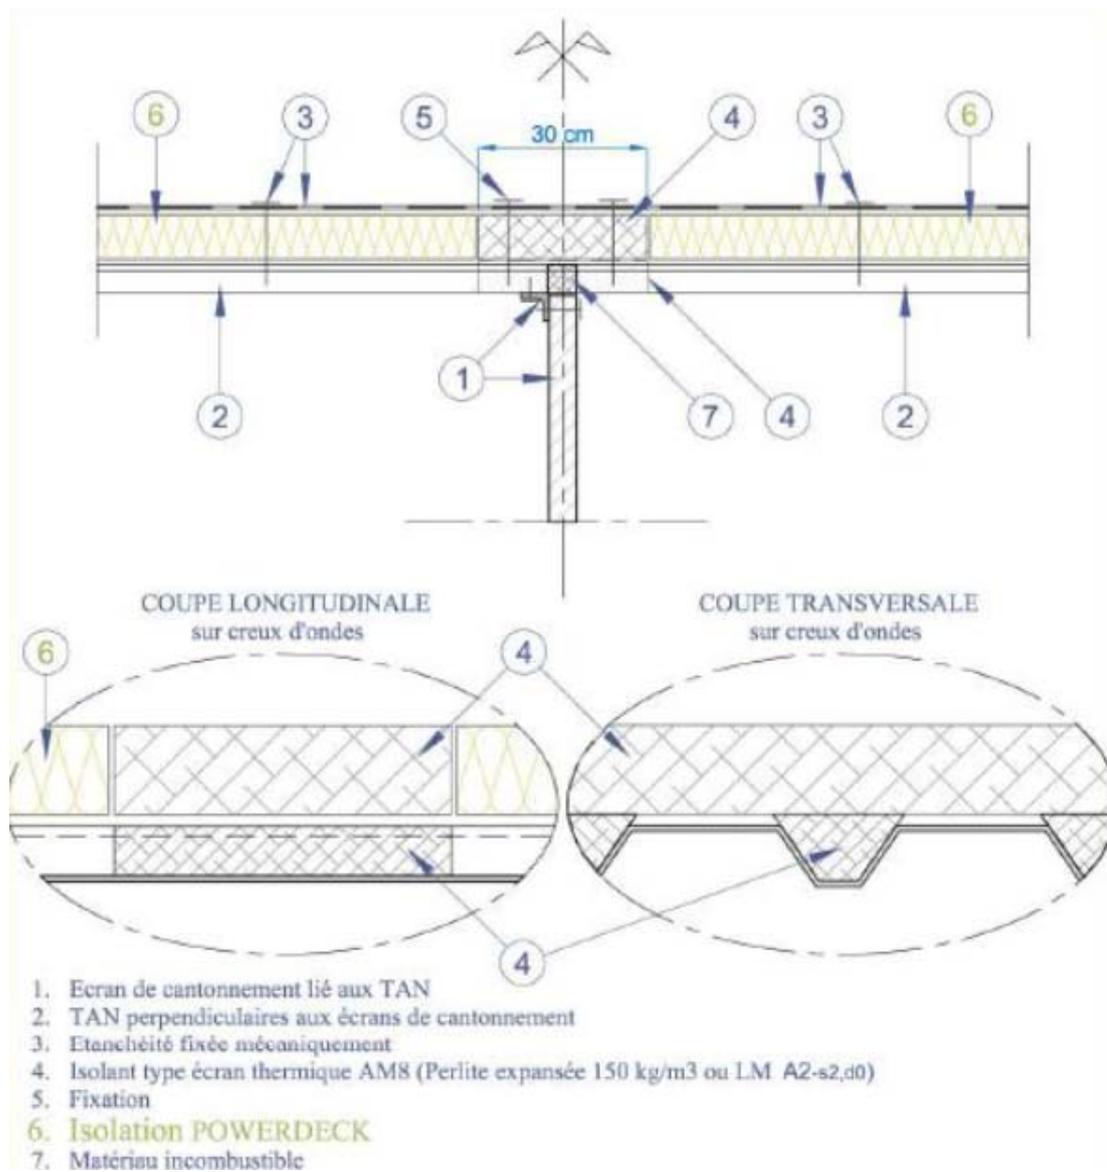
POWERDECK en ERP sans écran thermique : Exemple de recoupement au droit d'un écran de cantonnement sur TAN perpendiculaires aux écrans de cantonnement
